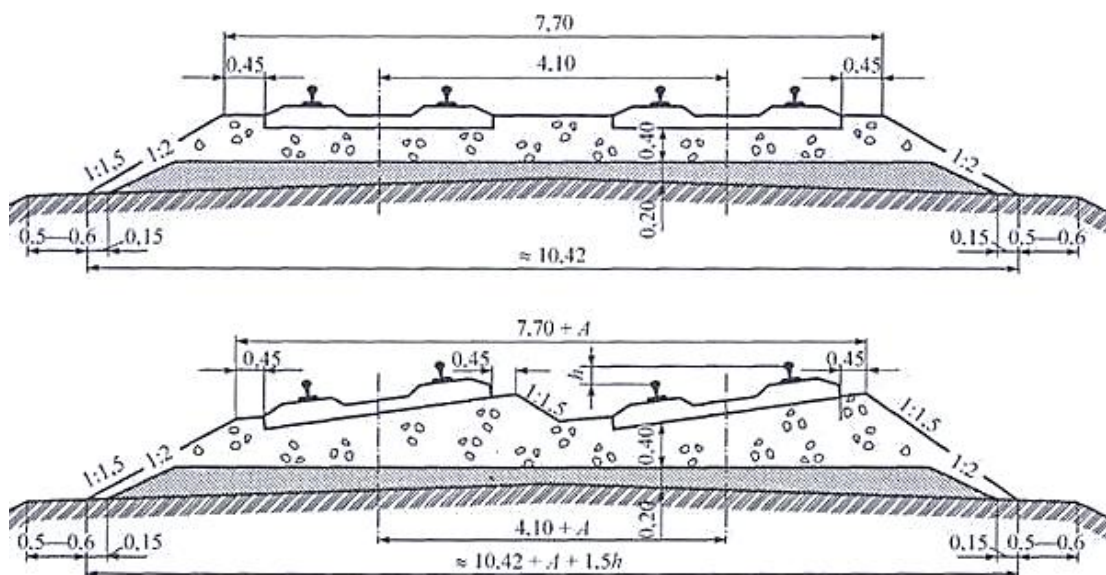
Конструкция балластной призмы с железобетонными шпалами
